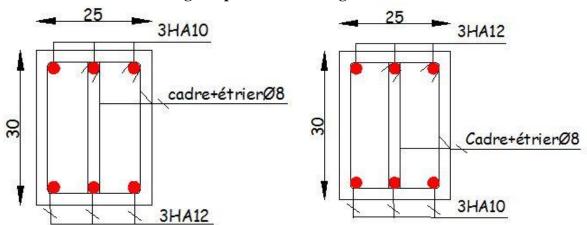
schéma de ferraillage de la poutre de chainage en travée et en appui.
